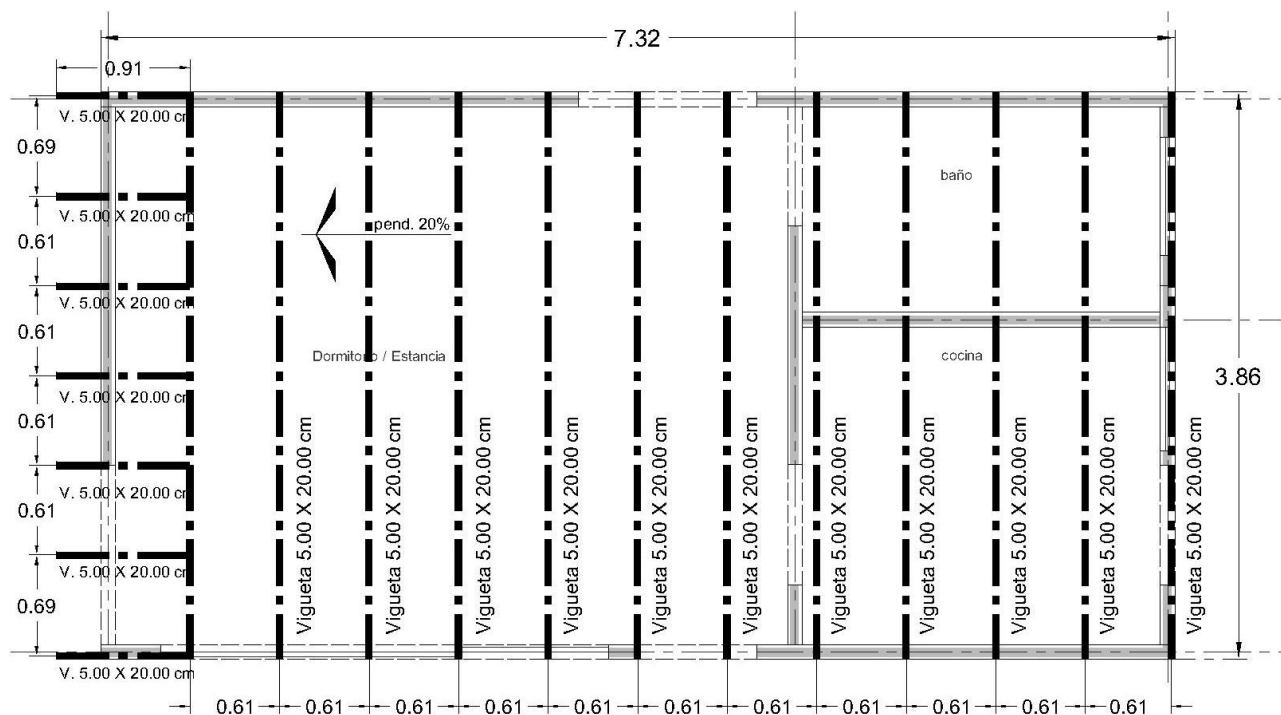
Envigado de cubierta en Módulo multifunción A. Fuente: Autoría propia, 2015.
